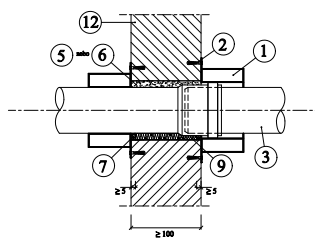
Detail E - prostup potrubí v masivní stěně - zapuštěná varianta - konfigurace U/U (vlevo) nebo U/C (vpravo)
